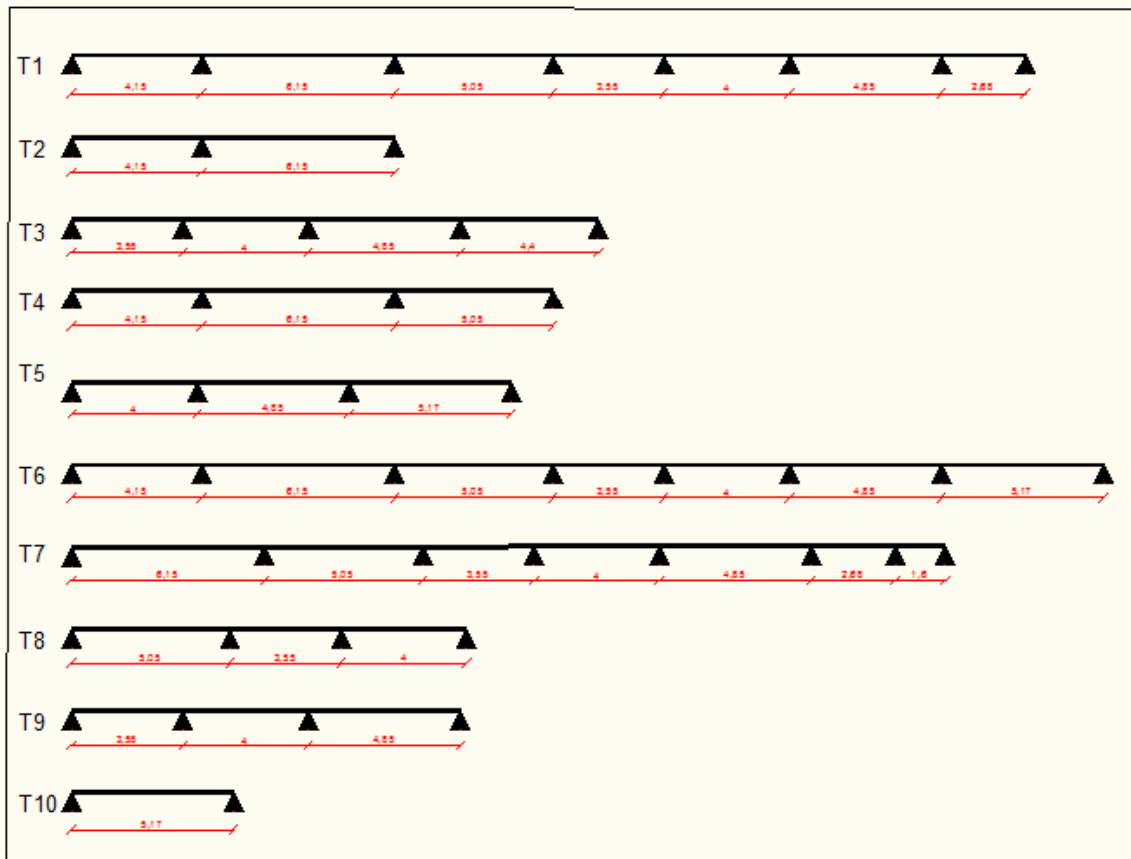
schémas statique des poutrelles de RDC jusqu'au 2^{ème} niveau duplexe.
